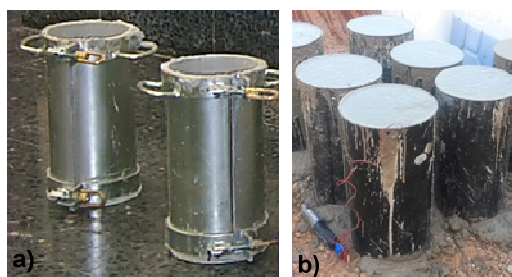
Moldes de probetas cilíndricas de dimensiones estándar. a) Moldes metálicos. b) Moldes plásticos.
